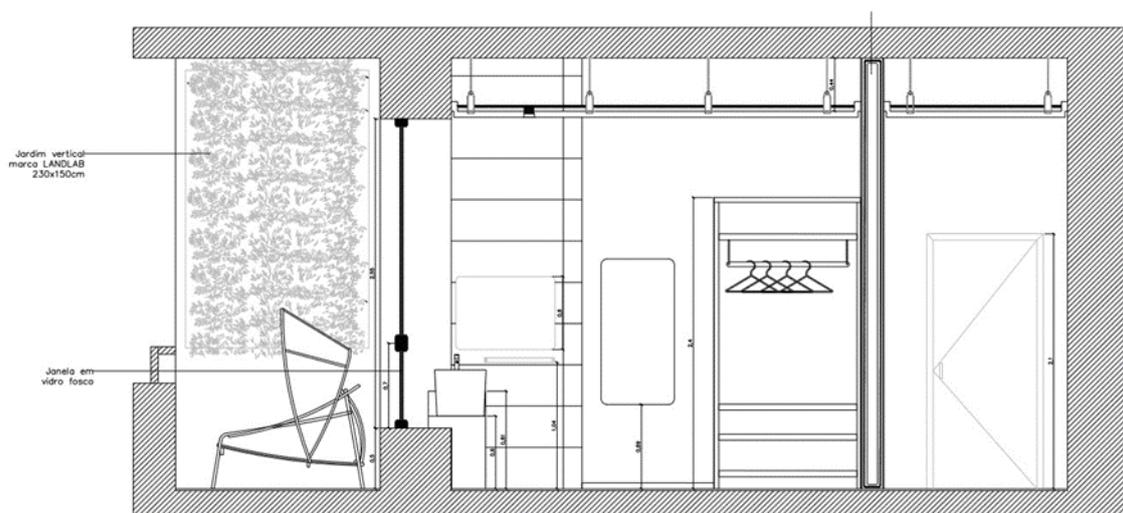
Pormenor Casa de Banho Quarto - Corte C - Escala 1:20
